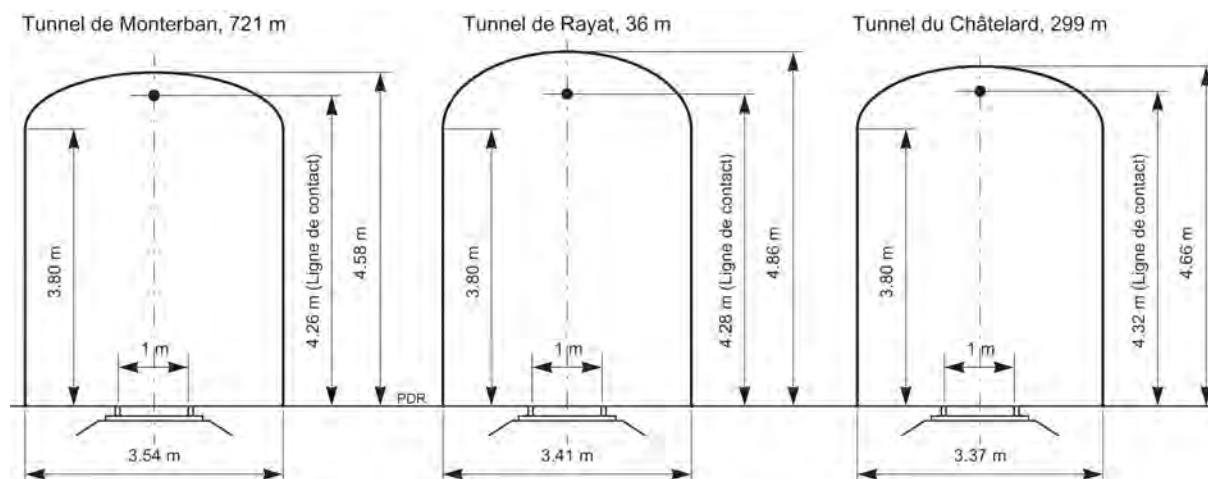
Coupe transversale des tunnels de la ligne Le Locle–Les Brenets ¹⁴
